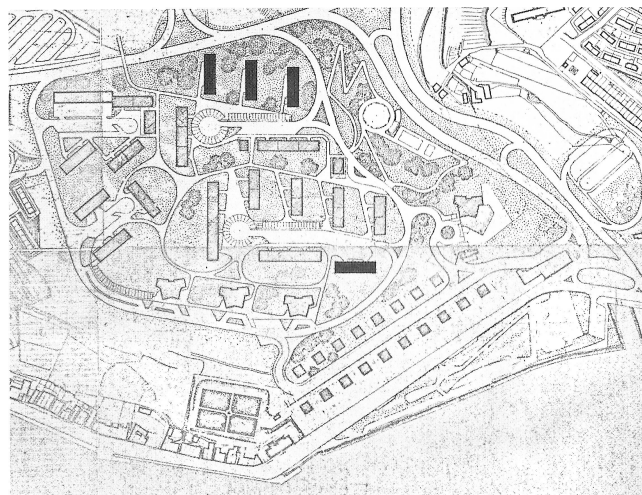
Planta de conjunto do plano do bairro da Pasteleira
